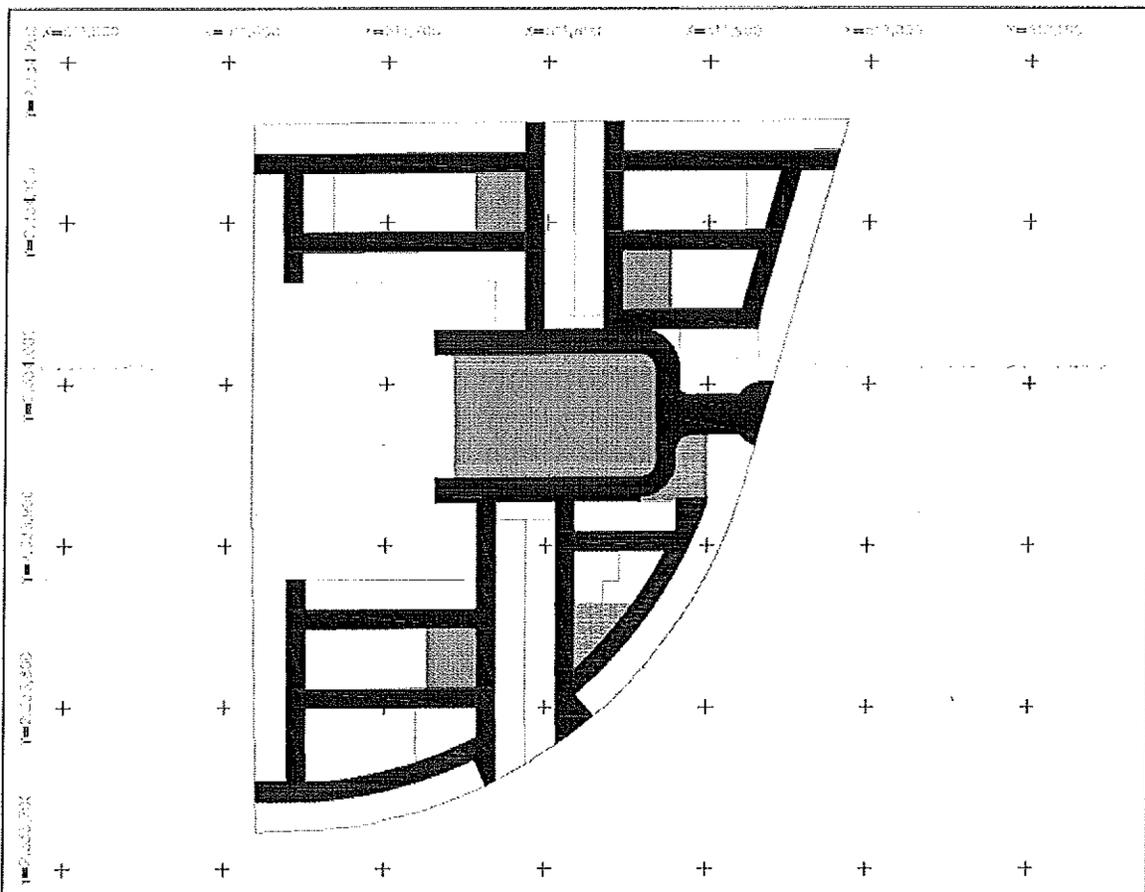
Distribución espacial de las áreas verdes del proyecto Maderos Residencial donde se pretenden reubicar las plantas rescatadas.
